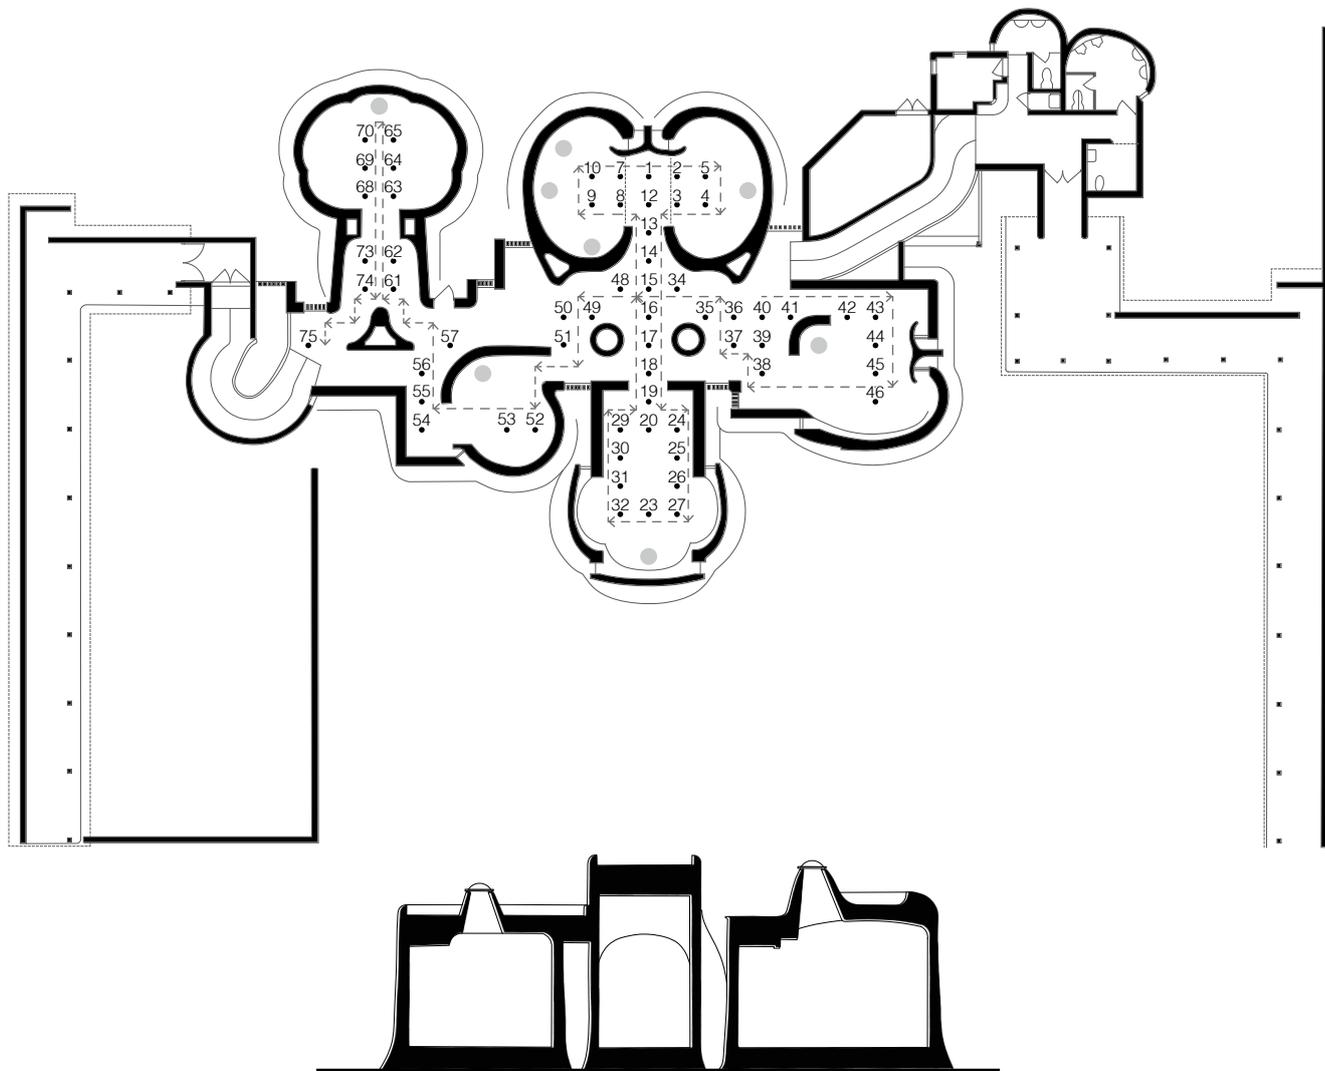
谷村美術館の平面図と撮影地点及び断面図
